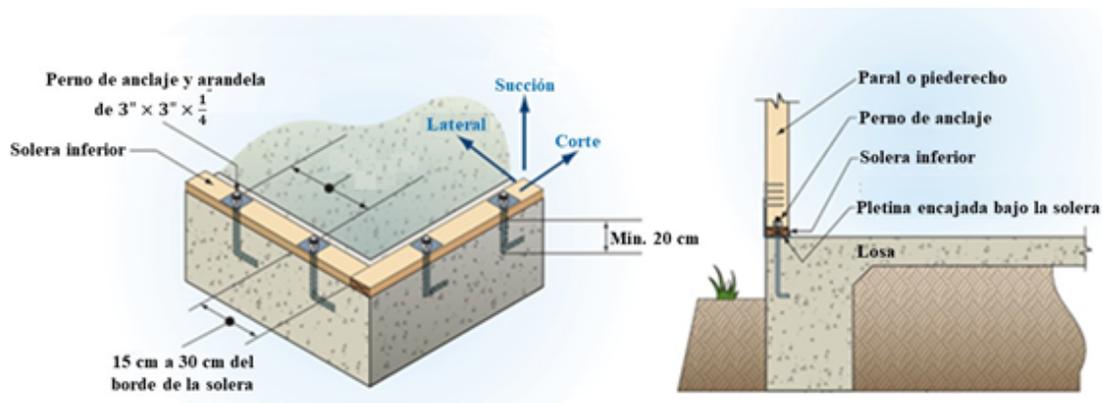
Detalle anclaje contra placa flotante (American Wood Council, 2015)
